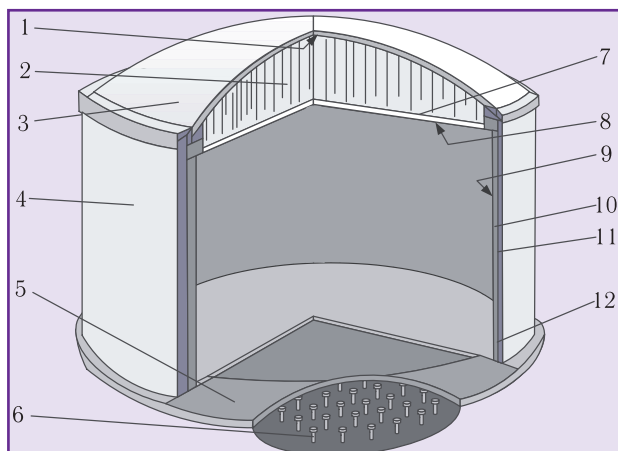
Железобетонный изотермический резервуар с замкнутой наружной оболочкой: 1 — подкладка крыши; 2 — подвеска; 3 — железобетонная крыша; 4 — боковая стенка из портландцемента; 5 — железобетонная стена основания; 6 — железобетонные сваи; 7 — изоляция крыши; 8 — подвесная платформа; 9 — внутренний корпус; 10 — теплоизоляция стенки резервуара; 11 — подкладка; 12 — вторичная перегородка
